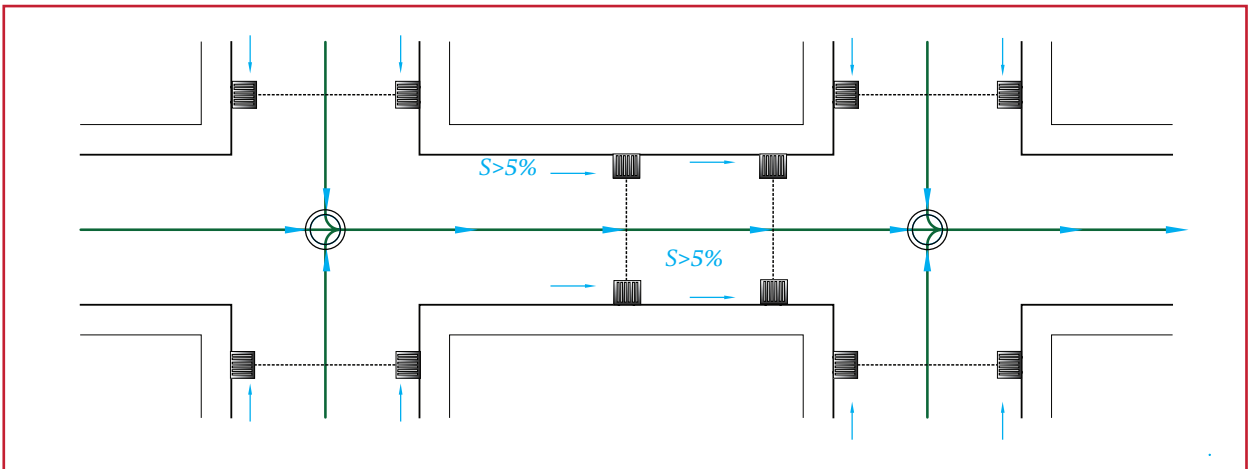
Ubicación de coladeras longitudinales de banqueta
